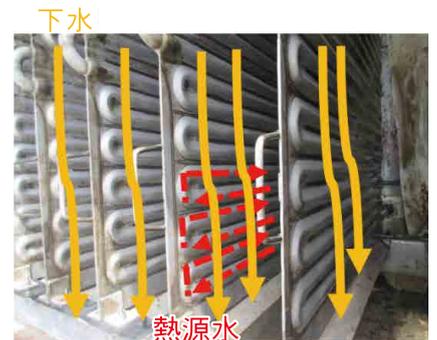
④伝熱プレート（流下液膜式熱交換器）
